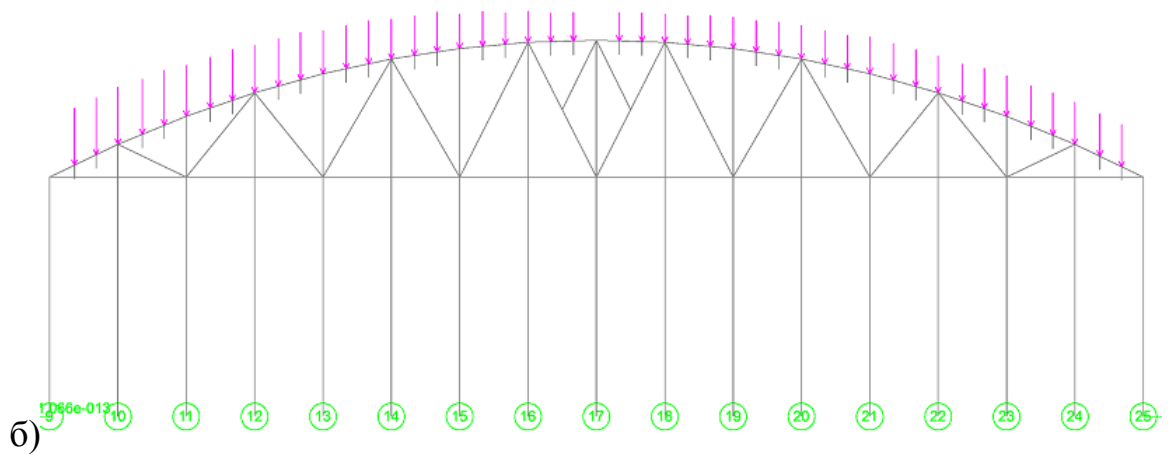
Загружение от снеговой нагрузки: а) на половина пролета слева; б) весь пролет по схеме 2 для зданий со сводчатыми очертаниями СП 20.13330.2011; в) весь пролет по схеме 2 для зданий с двускатной кровлей СП 20.13330.2011.
